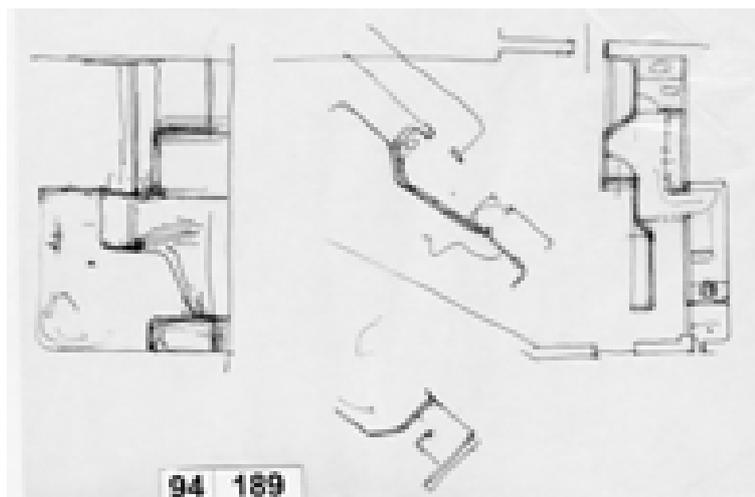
Studio pianta quota +0,00 – s.d. (AABS-94.189)
